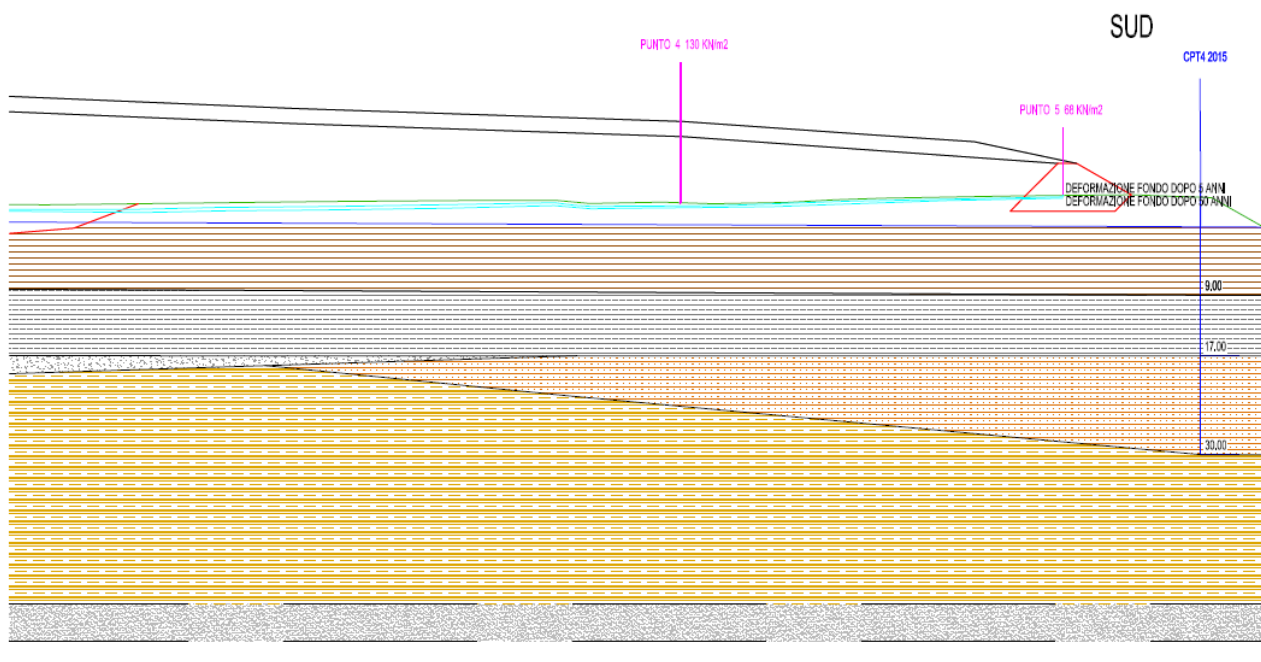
sezione 1 NORD – SUD deformabilità del fondo
